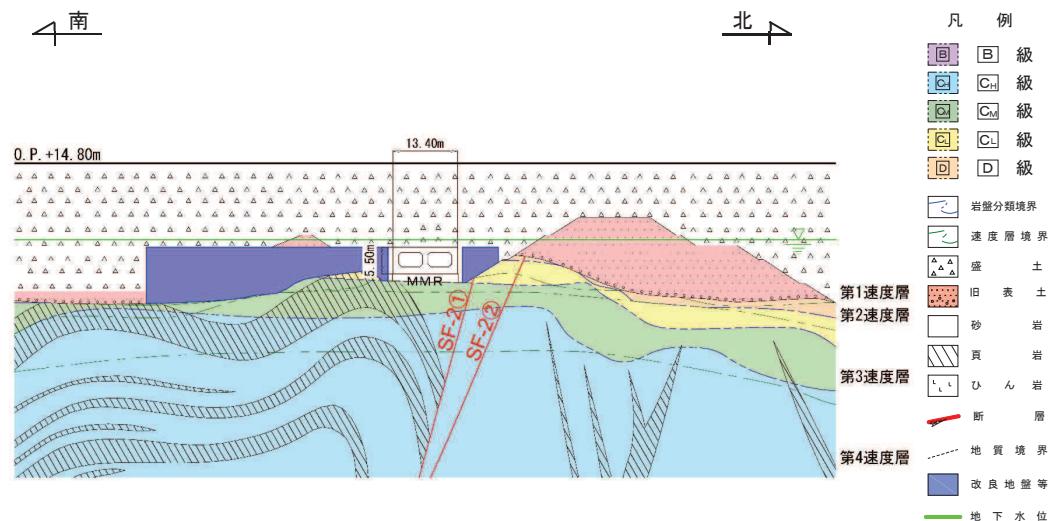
(5) 取水路（標準部） 地震時荷重算出断面図（断面⑥：曲線部）
